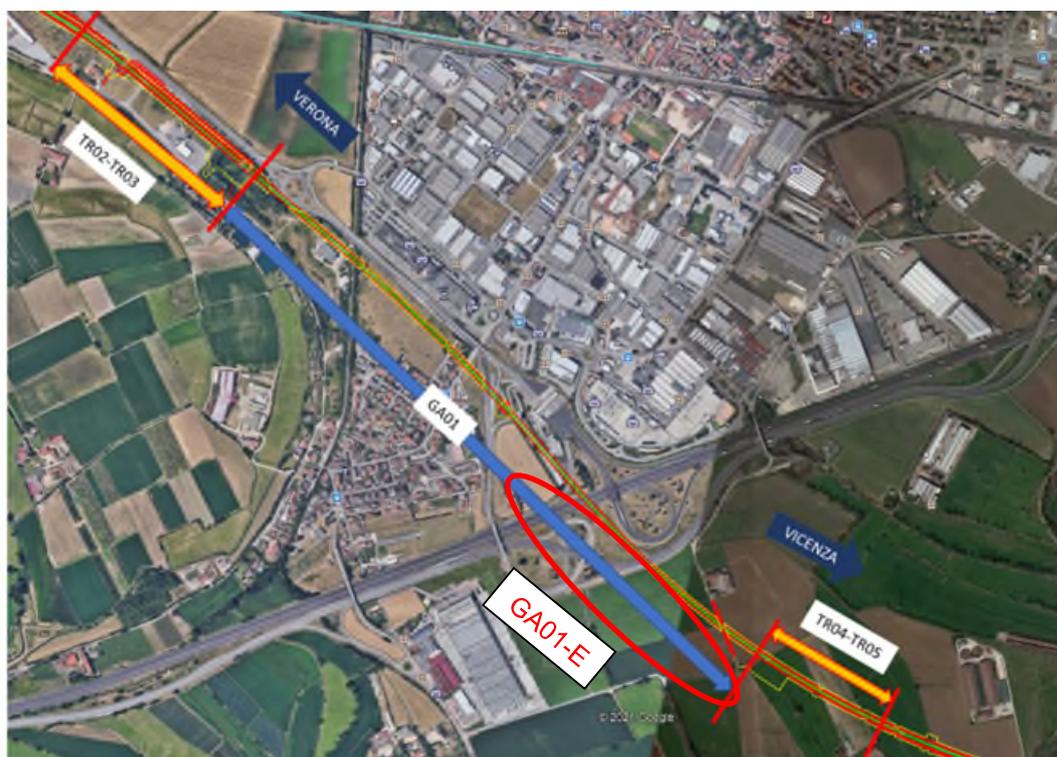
Planimetria di inquadramento galleria artificiale GA01 e trincee
